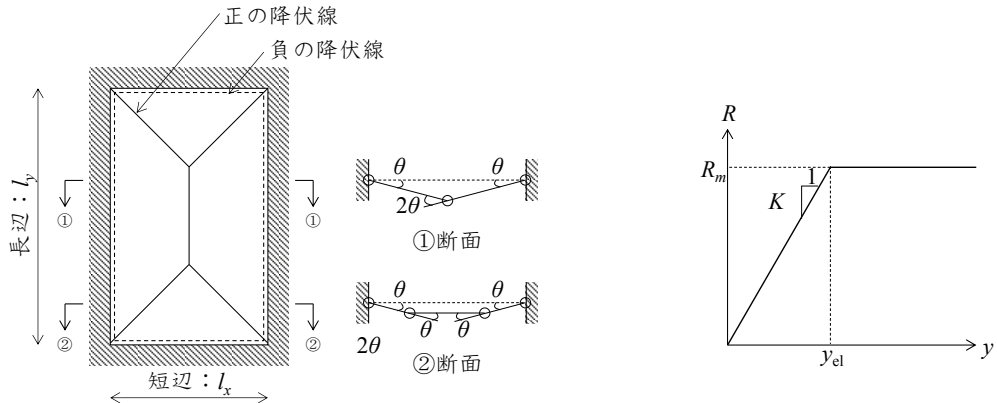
4 辺固定の鉄筋コンクリート版の曲げ変形図
